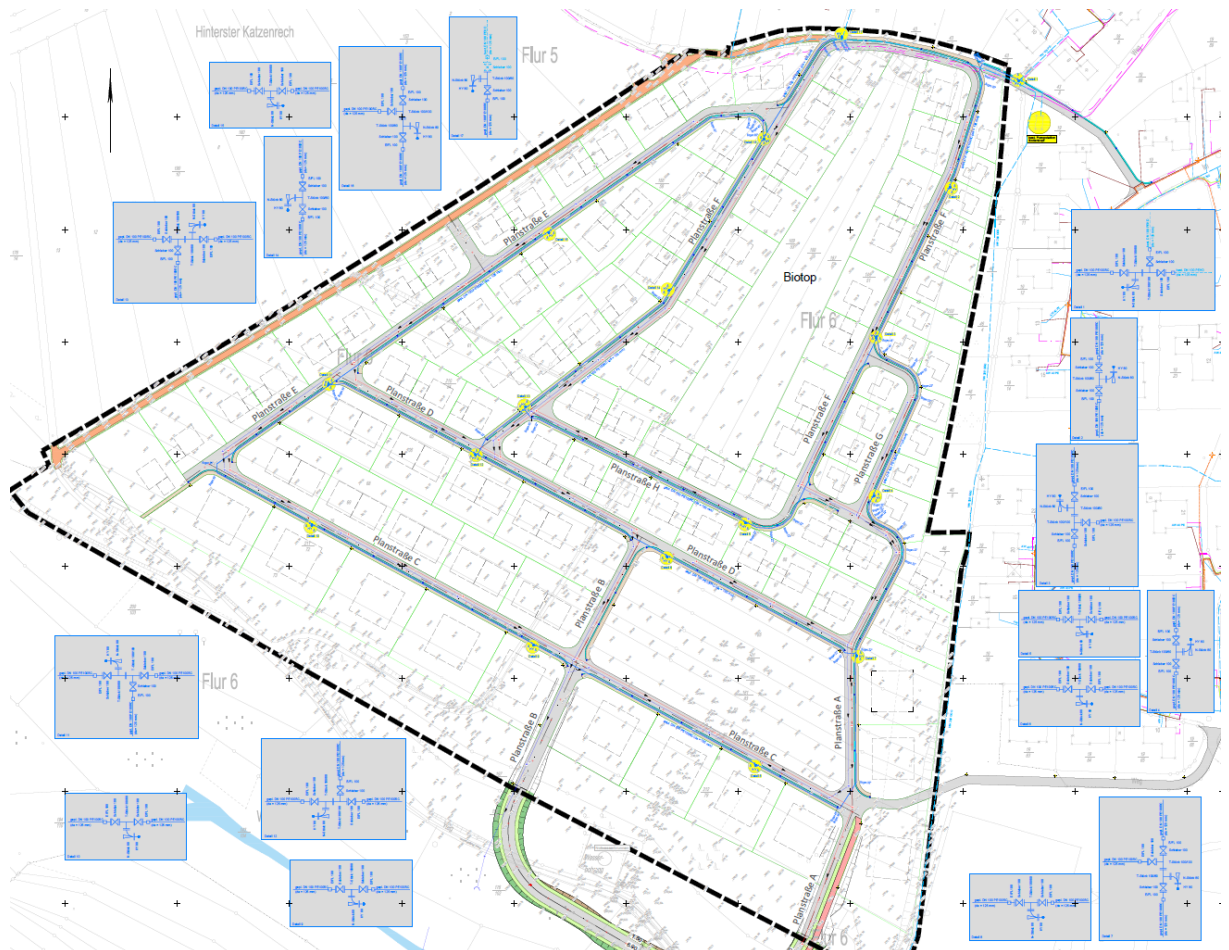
Lageplan Wasserleitung, o.M. (Quelle: P & P GmbH)
